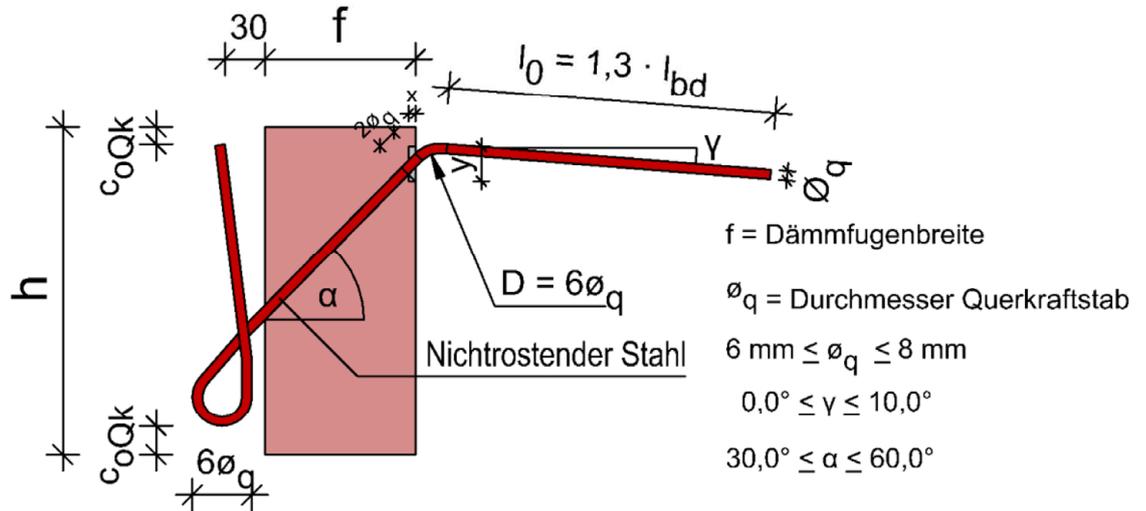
Ausführung Querkraftstab mit Schlaufe
